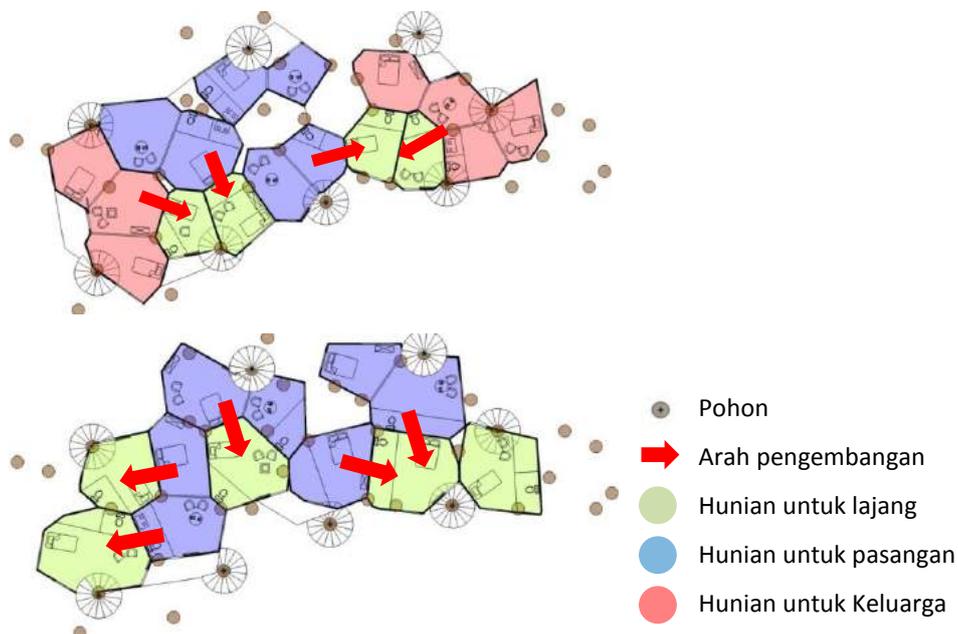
Layout Plan konfigurasi rumah pohon (elevasi +4.00) dan skematik interkoneksi
